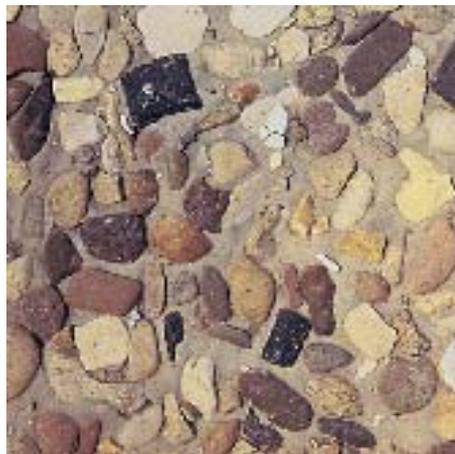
Ausgewaschene Betonoberfläche, farbiger Zuschlag mit rundem Korn, grauer Zement
